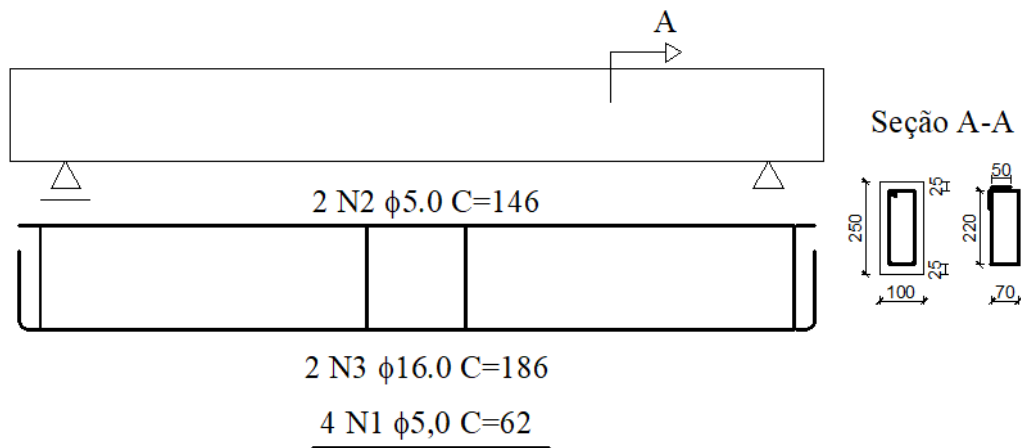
Detalhamento das armaduras da viga. Adaptado de SAVARIS (2017).
